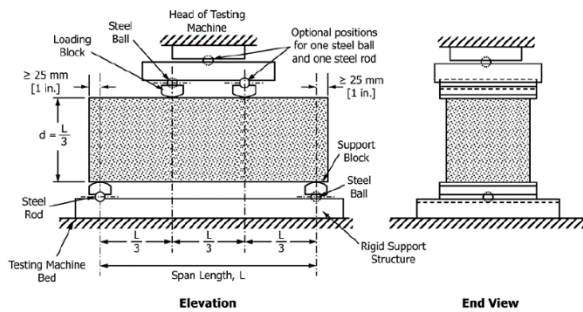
Esquema para la falla flexional de una viga de concreto hidráulico. Fuente: ASTM C78. Prueba de resistencia a la flexión del concreto.
